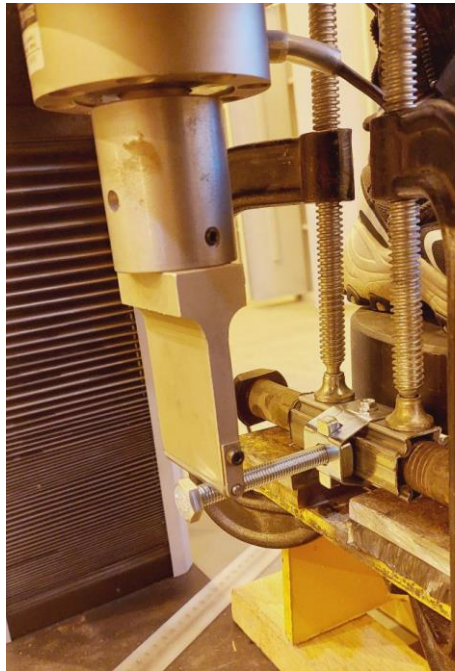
Образец для испытания подвеса на срез поперек стержня профиля
